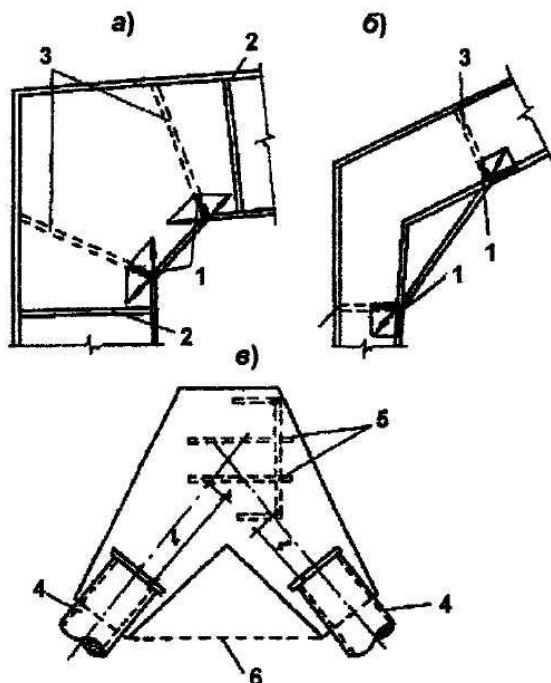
Схема узлов примыкания элементов стальных конструкций, приведших к авариям:
